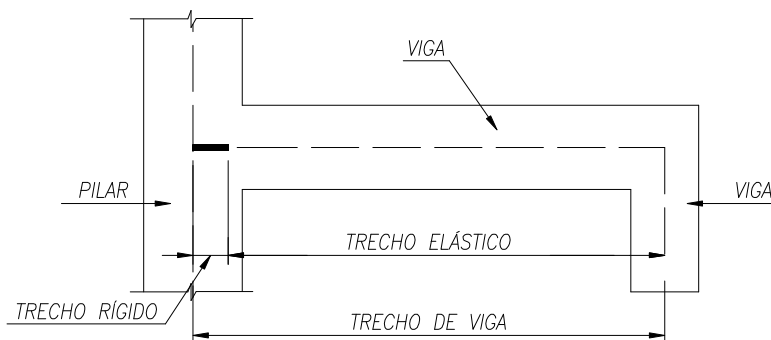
Trecho de Uma Viga que se Apóia em Uma Extremidade em Pilar e na Outra Extremidade em Viga
